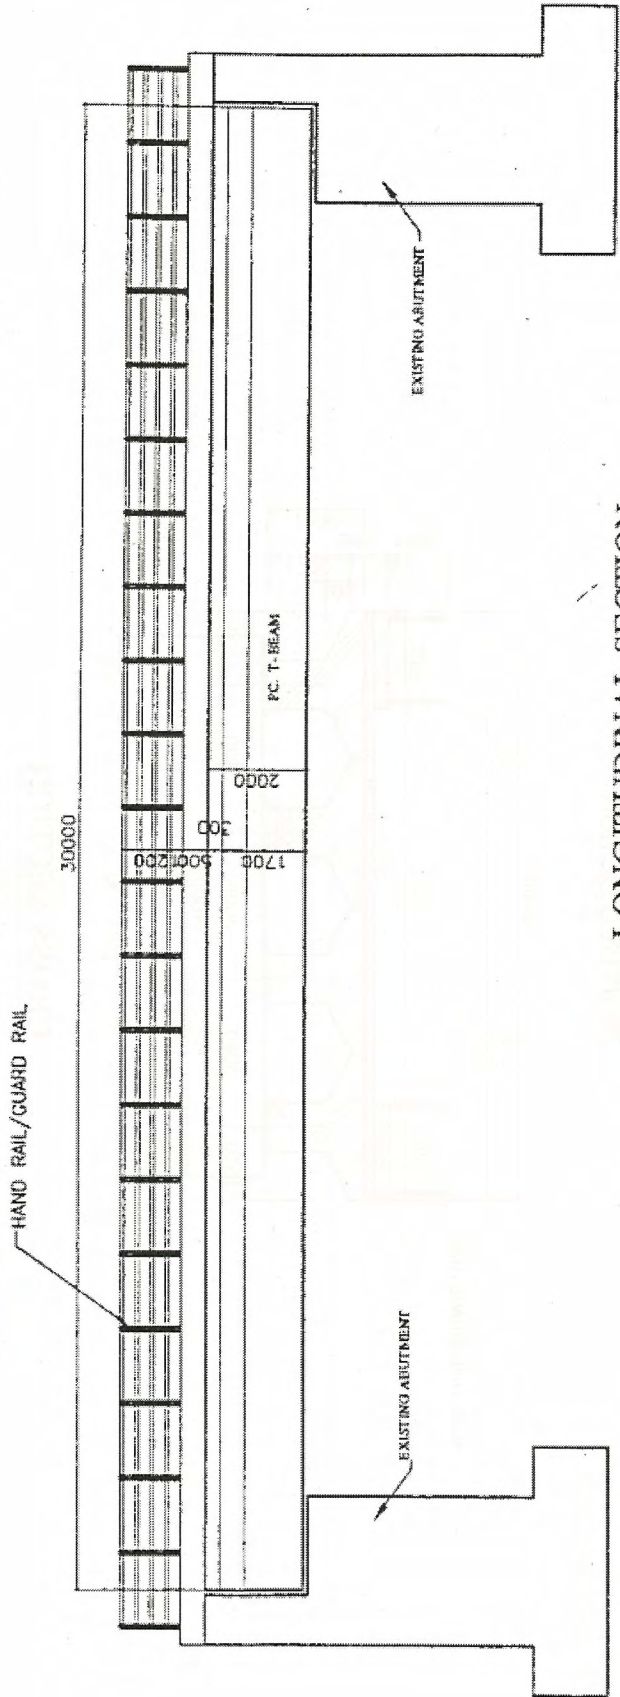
要請書のカトゥンベラ橋の断面図と側面図
